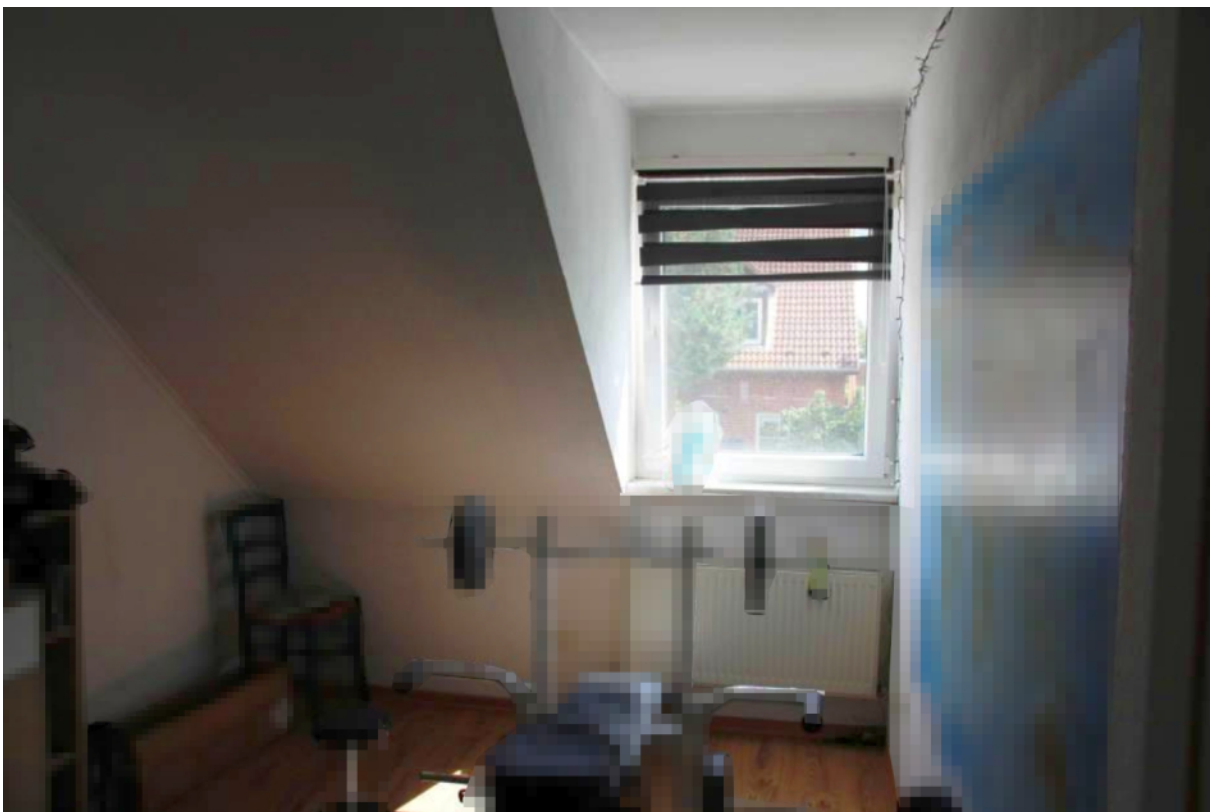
Mauerwerksriss im Bereich des Giebels
